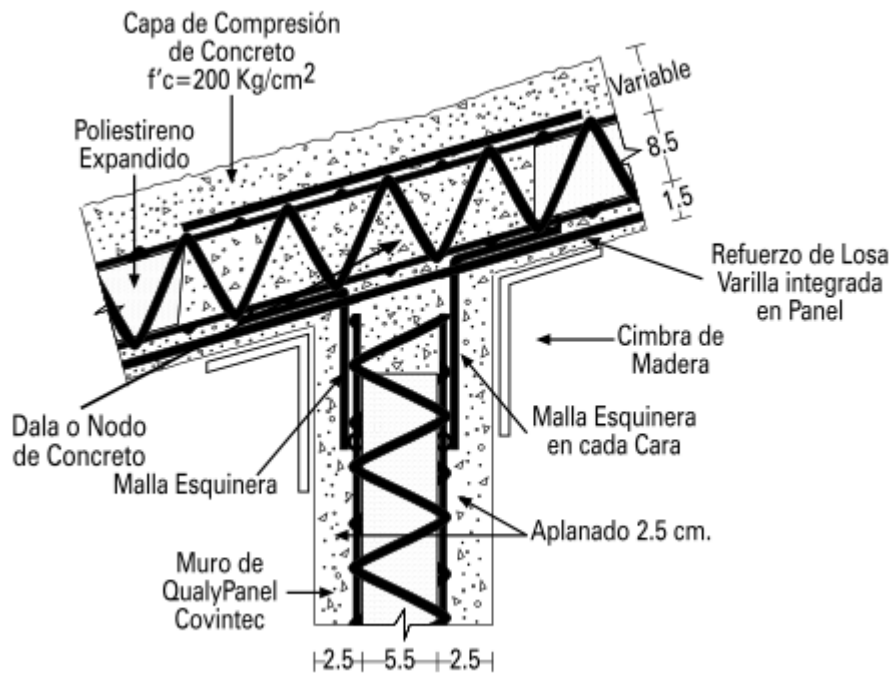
Unión entre muros y losa inclinada (Corte).
